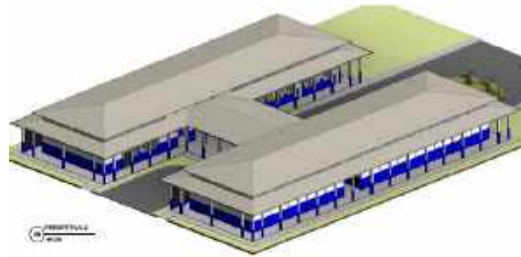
Vista da Fachada Sul/Leste do Pavilhão. (FAUSTINO, 2018 apud RACHID, 2018).
